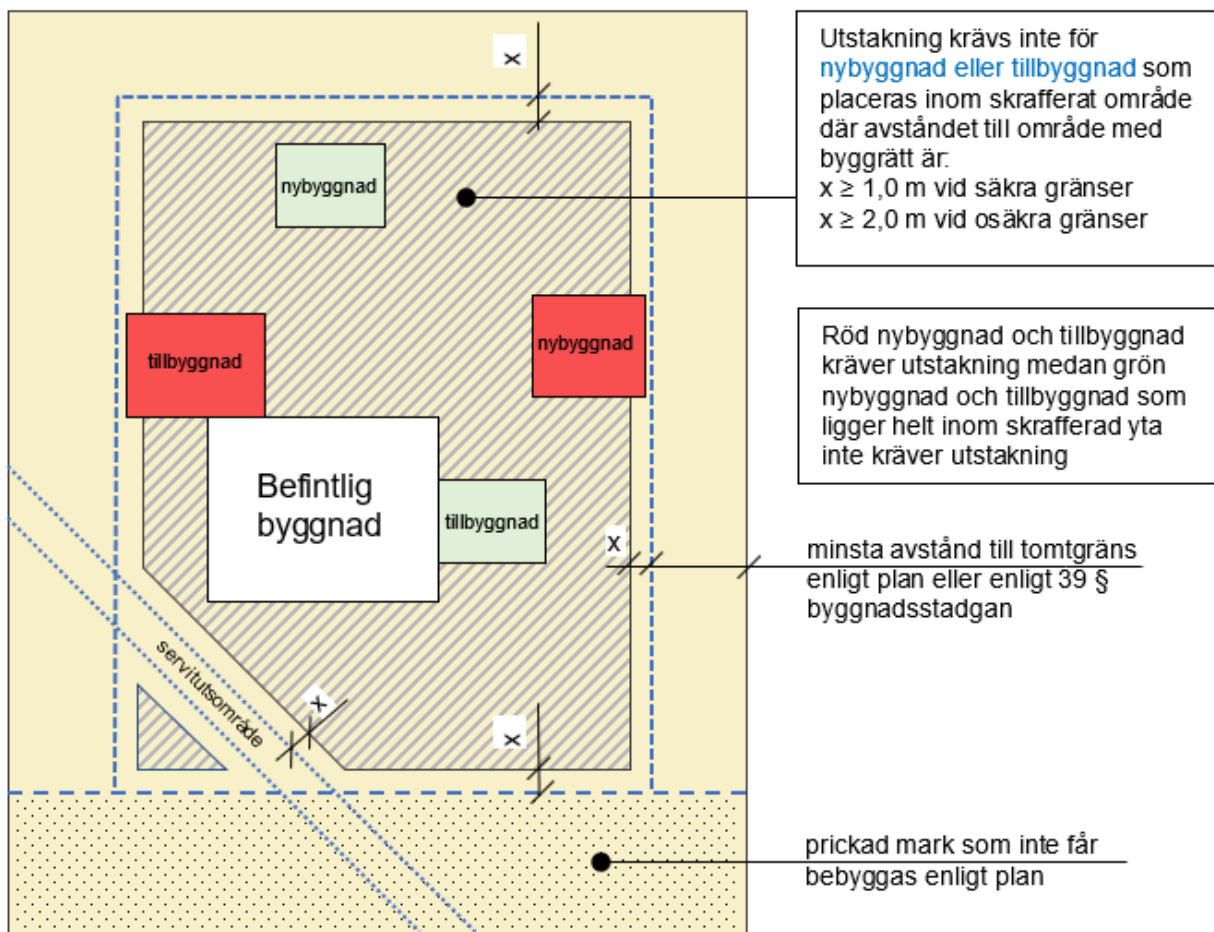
Utstakning där planbestämmelser eller servitut avgör om utstakning krävs.
